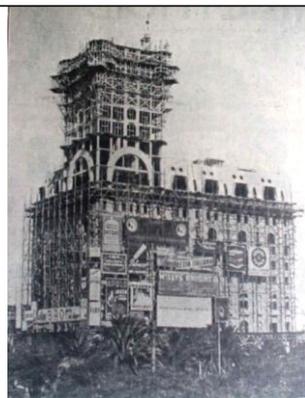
El Palacio Salvo en construcción. Rev. Arquitectura N° 87 Año
